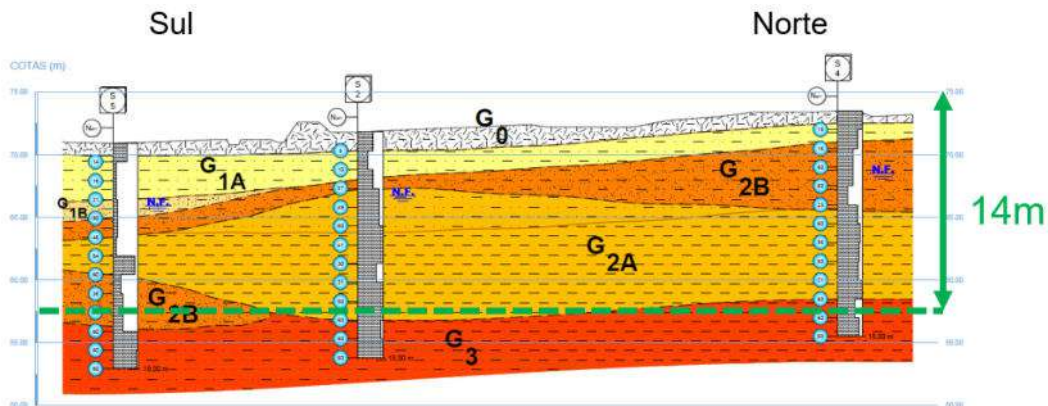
Perfil geológico e geotécnico Sul-Norte (profundidade de escavação a verde).
